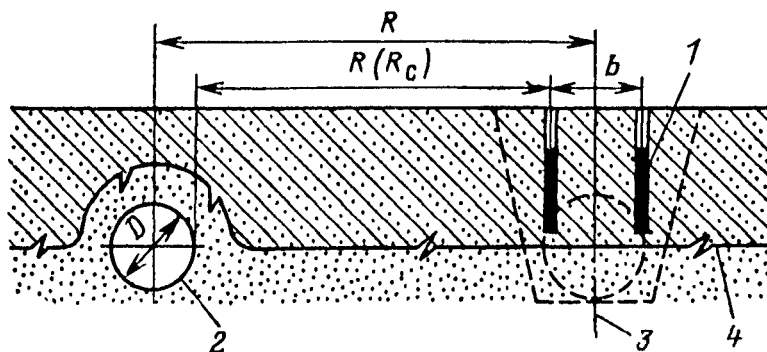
Схема расположения зарядов при сооружении траншей вблизи действующего трубопровода при рыхлении мерзлого грунта:
